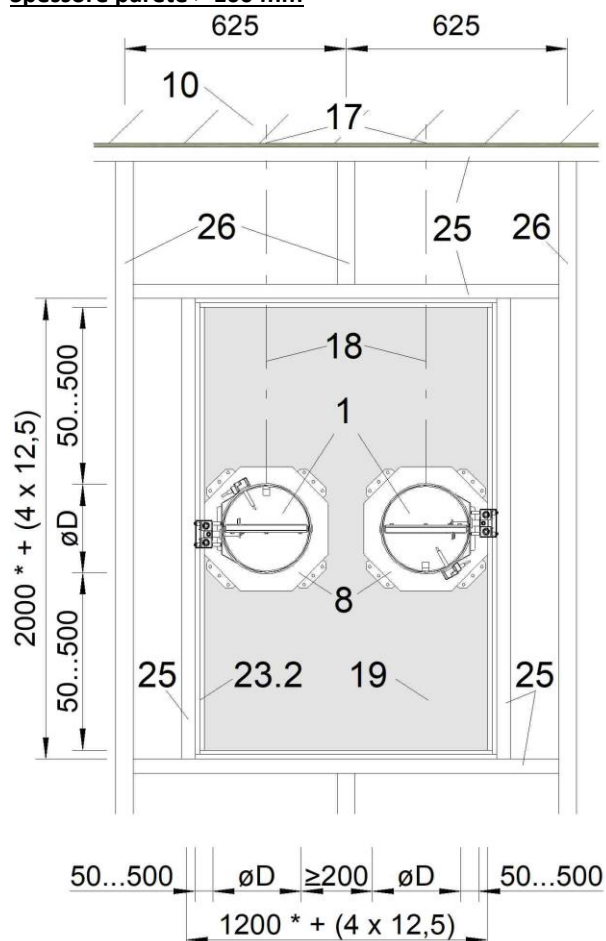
montaggio nella parete con struttura di supporto metallico (spessore parete = 100 mm)
